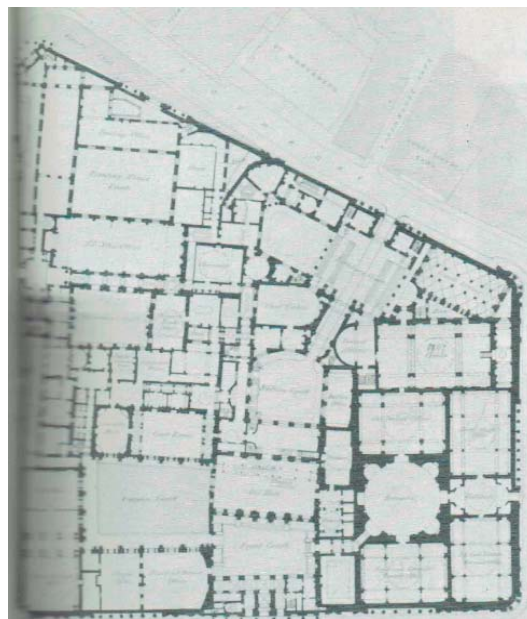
Plano de la planta baja del Banco de Inglaterra - Londres, 1788-1834 de sir John Soane: Plano.
